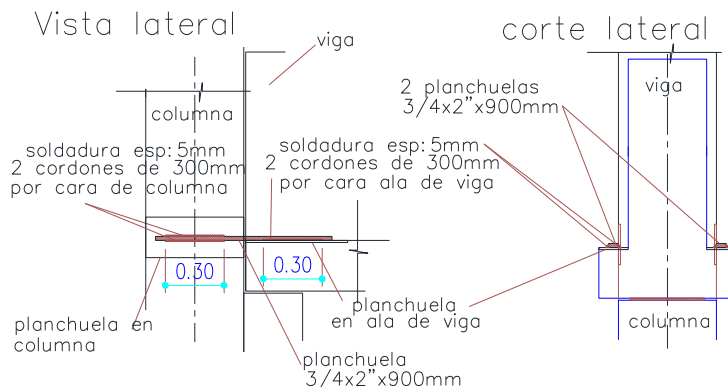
Detalle de unión soldada viga a columna
